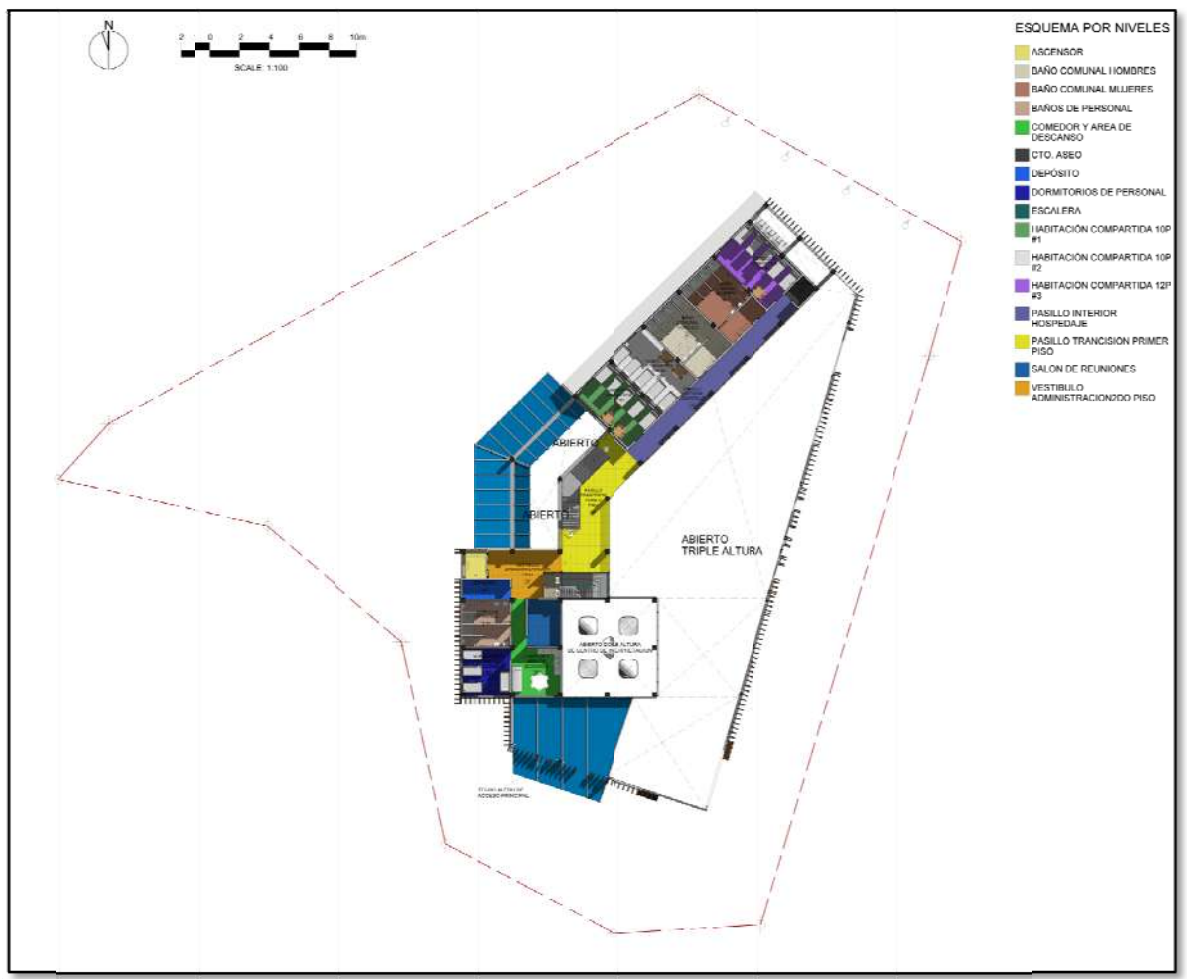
PLANTA ARQUITECTÓNICA N.100 SEGÚN ESPACIOS
